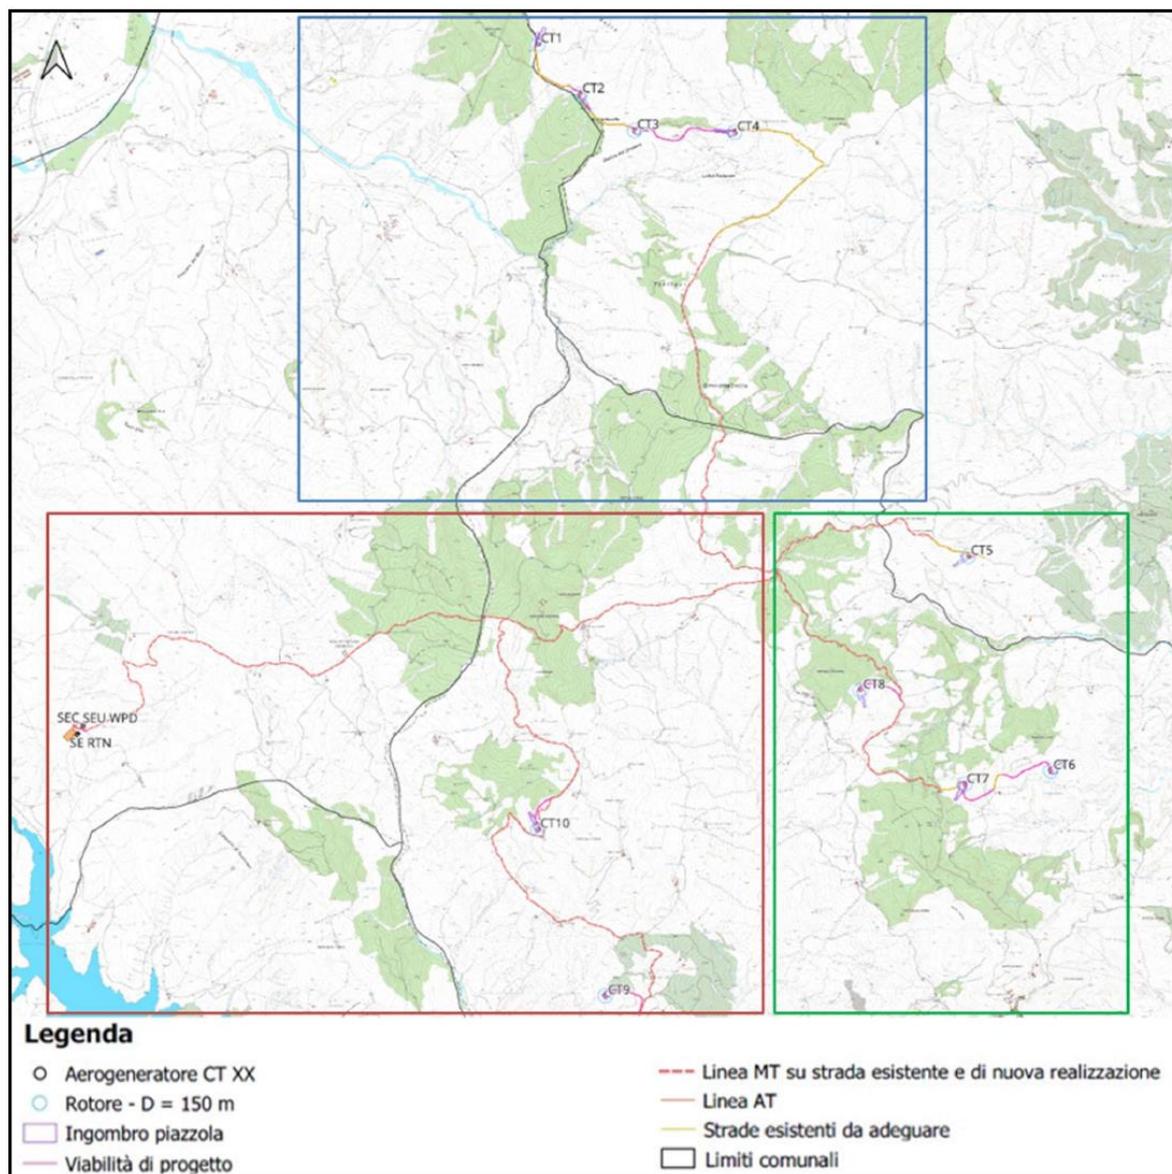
Layout d'impianto suddiviso in zone su CTR: Zona 1 - rettangolo rosso, Zona 2 - rettangolo azzurro, Zona 3 - rettangolo verde
